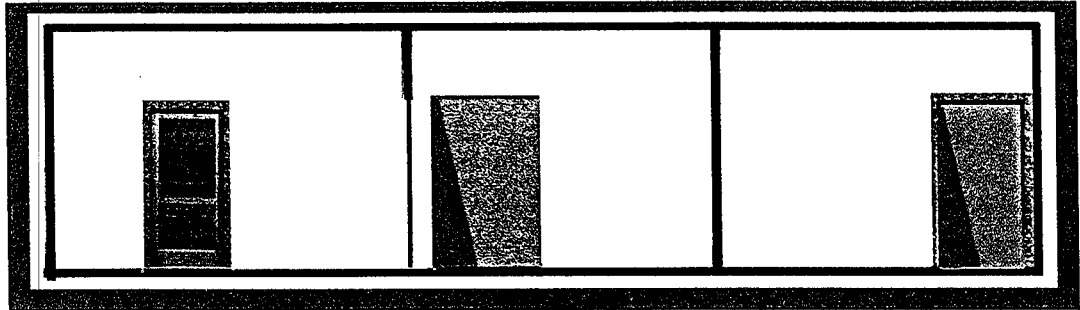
/١٢٤) مسقط أفقي يوضح قطاعاً بالشقة
